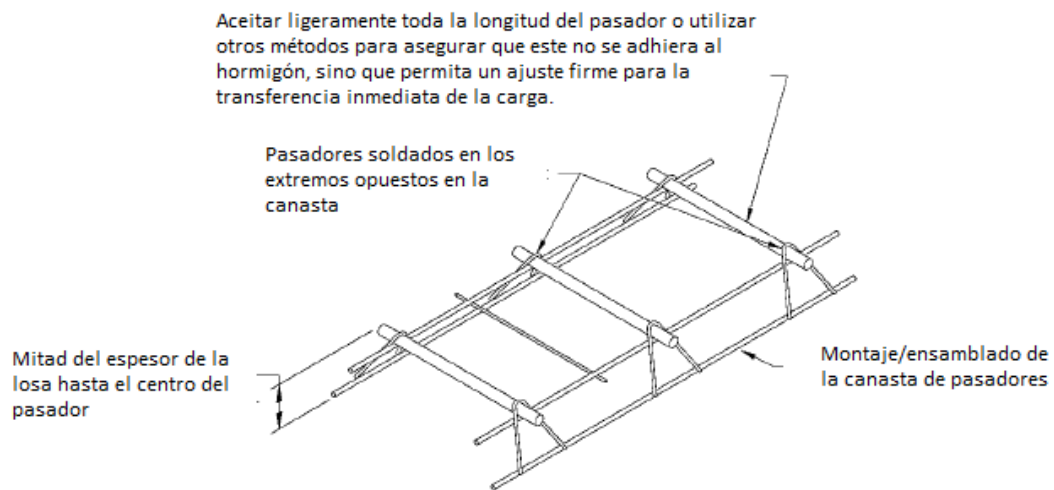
Ensamblaje de canastas para pasadores circulares (ACI 360, 2016)
